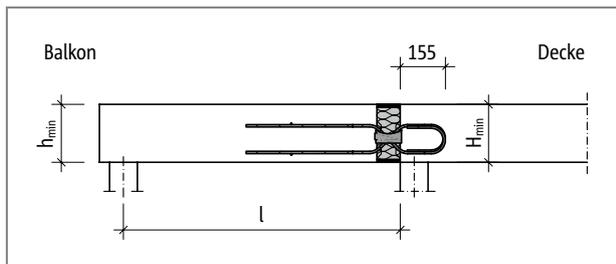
Schöck Isokorb® T Typ QL-VV1 bis Typ QL-VV3: Statisches System
